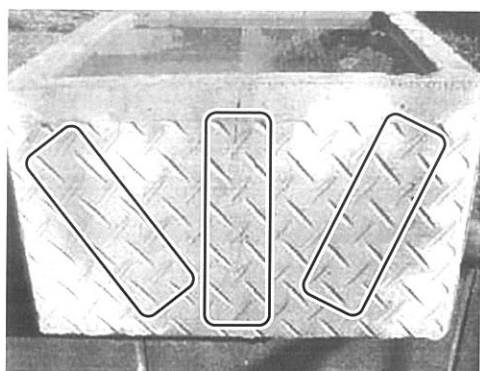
面Bでは3ヵ所ひび割れを設けた
